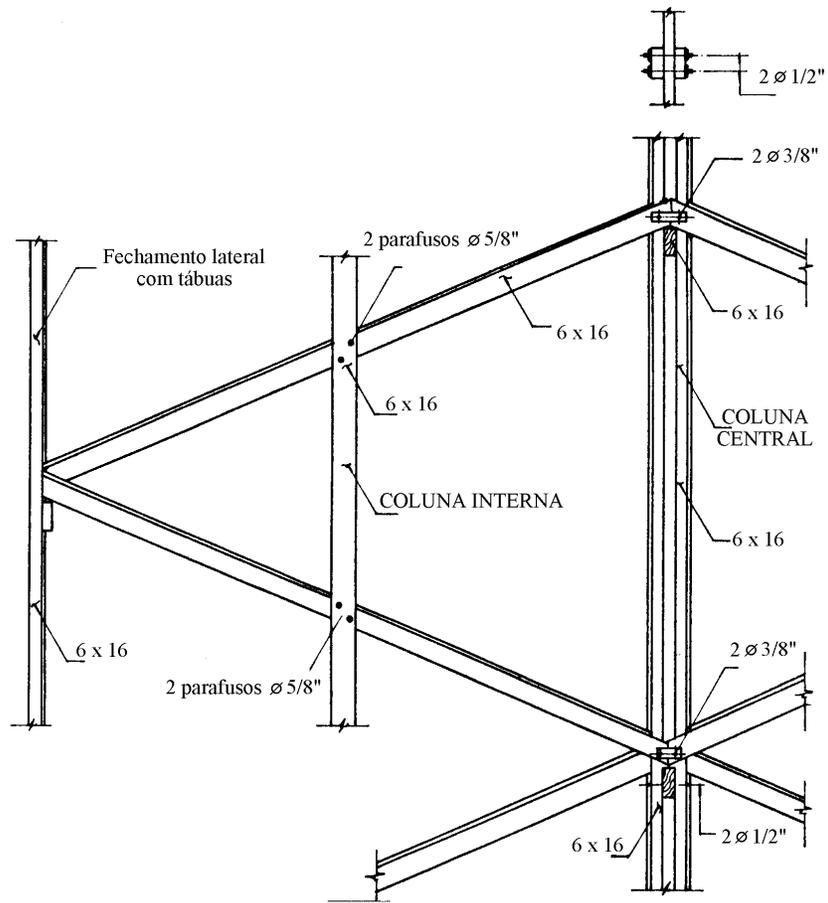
Detalhes das ligações entre rampa-colunas, rampa-viga e viga-coluna
